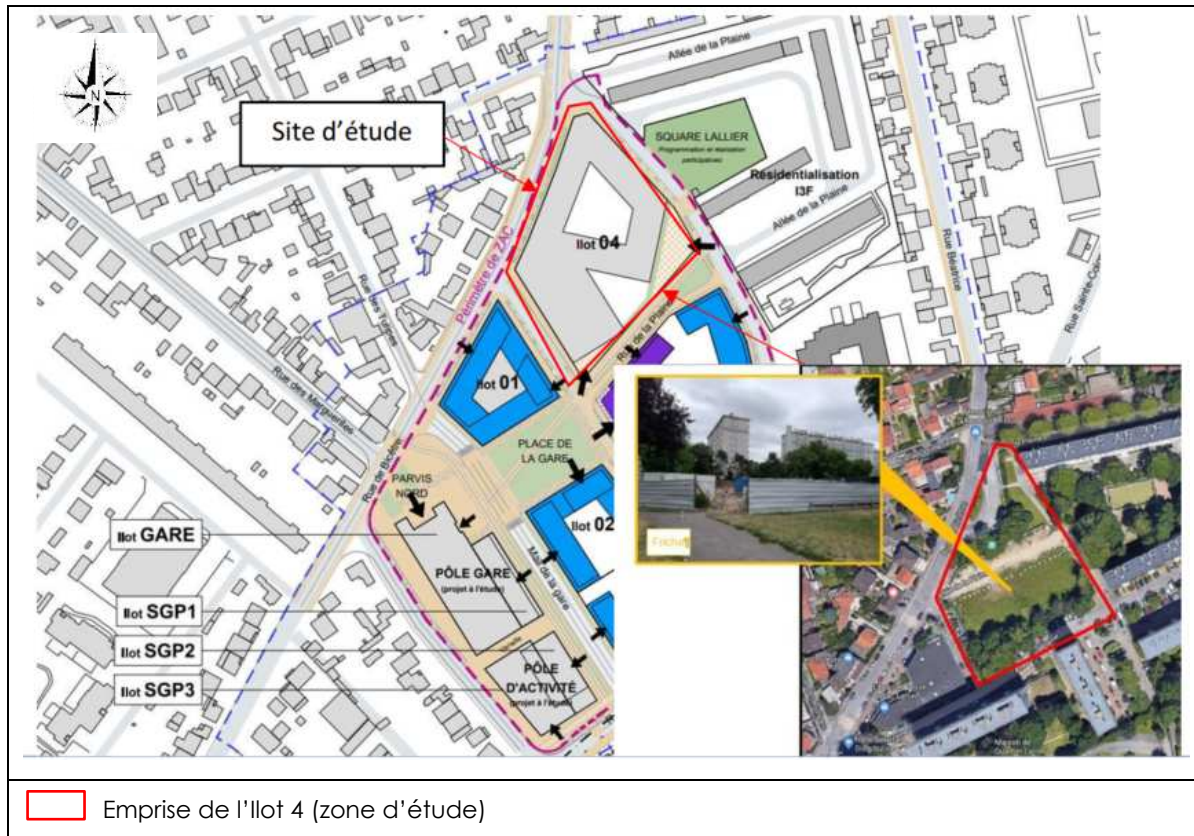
Plan des futurs logements et équipement du secteur Lallier – source : Etude d'impact (2020- sans échelle)
